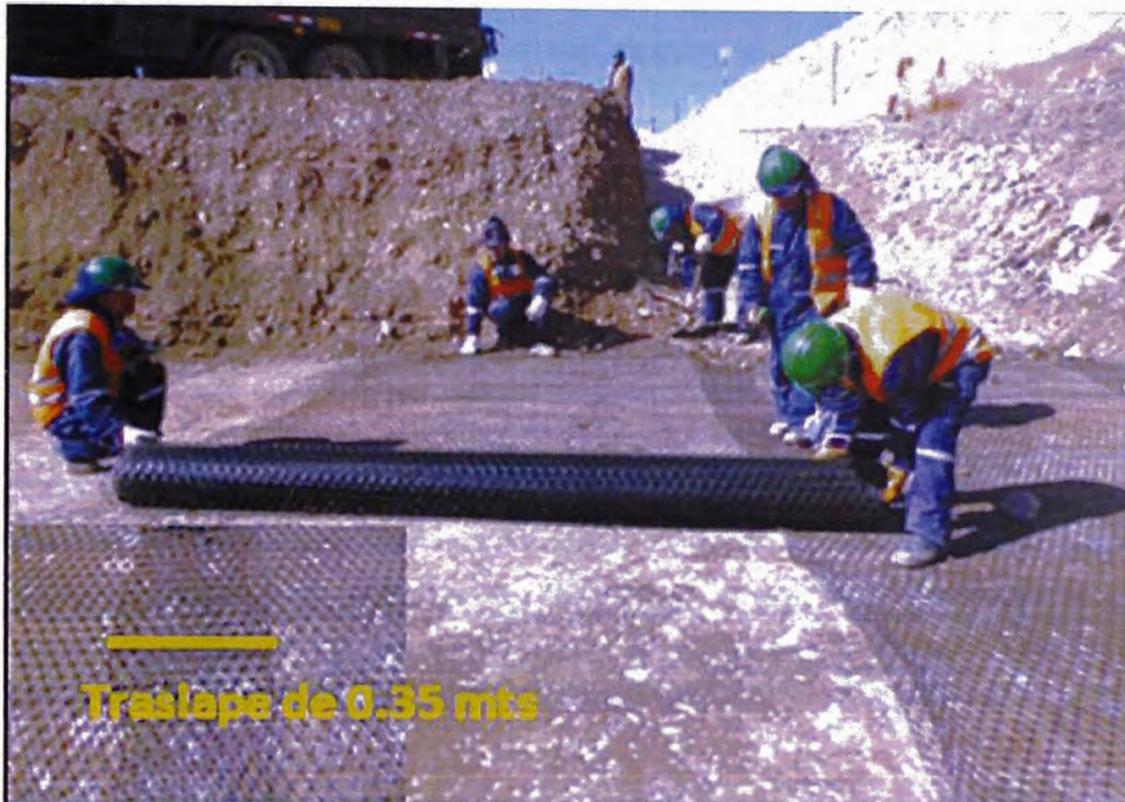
Instalación de Geomalla Triaxial con traslape de 0.35 m
